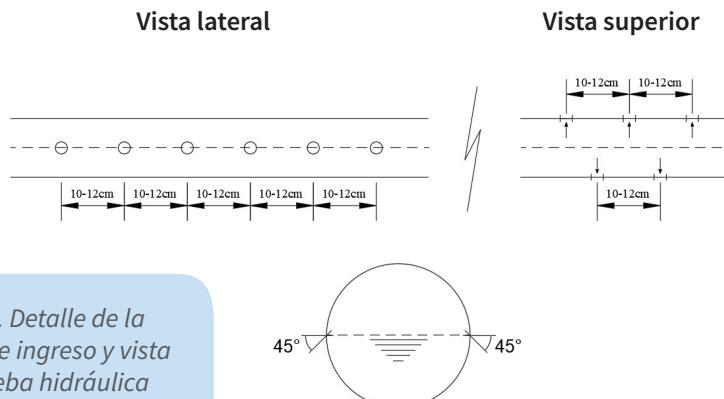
Detalle de la cañería de ingreso y vista de la prueba hidráulica para nivelar.
